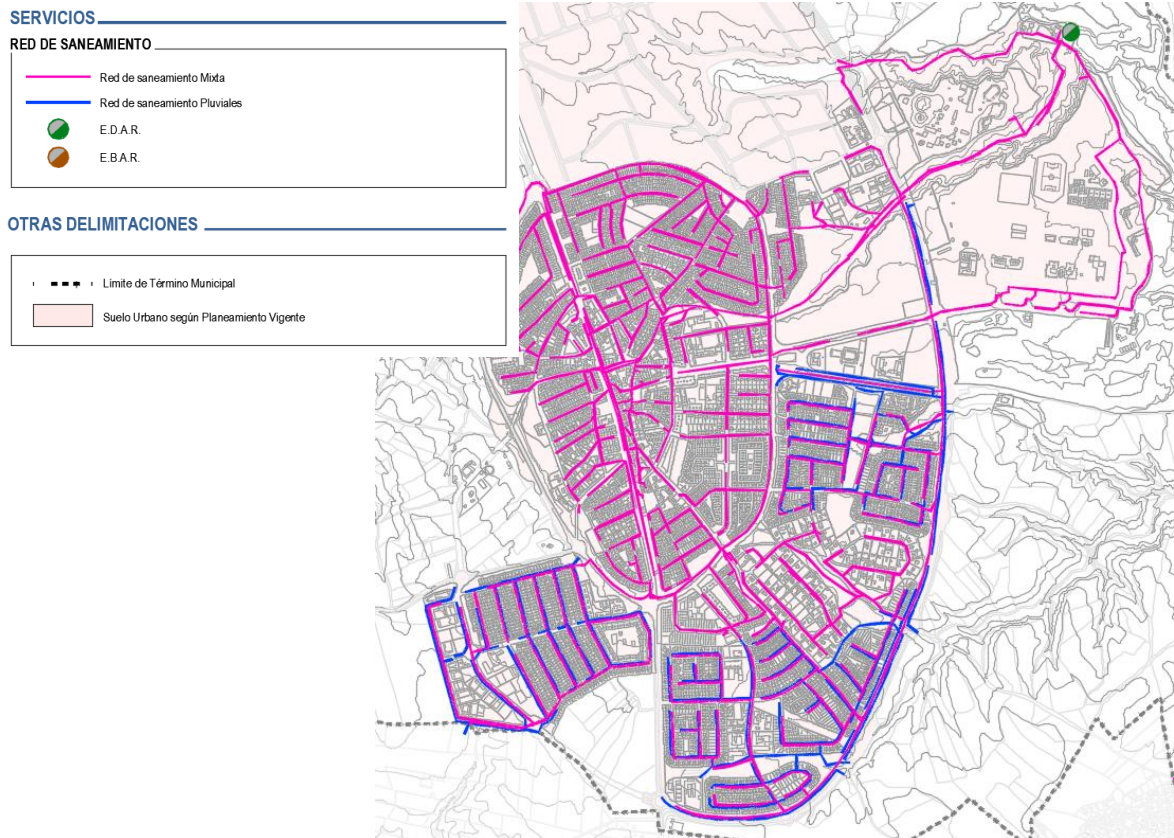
Red de saneamiento en Villanueva de la Cañada. Fuente: Elaboración propia.
